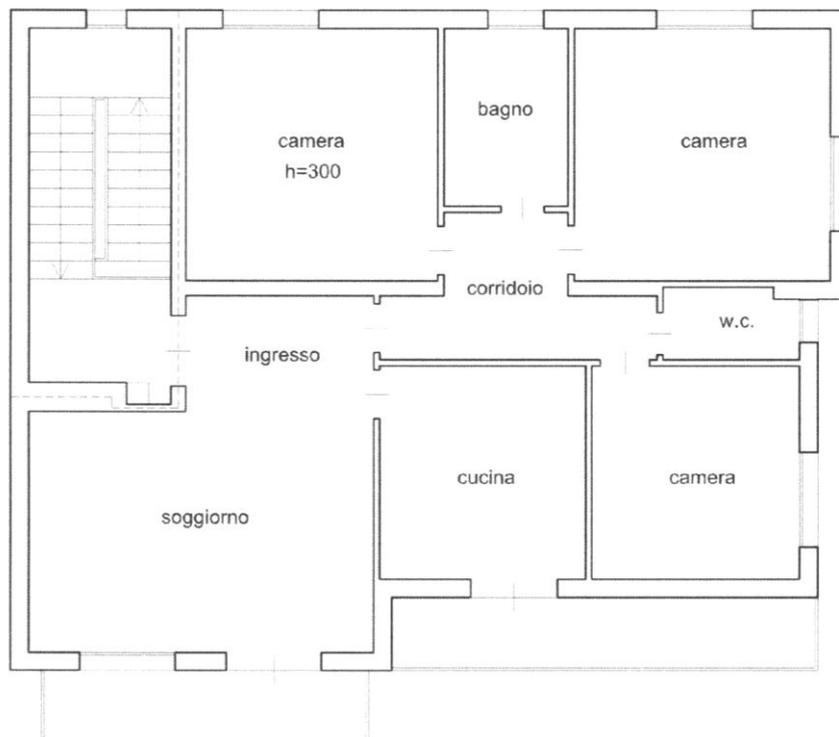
Planimetria immobili – Pianta Piano secondo ([Allegato 9](#))
